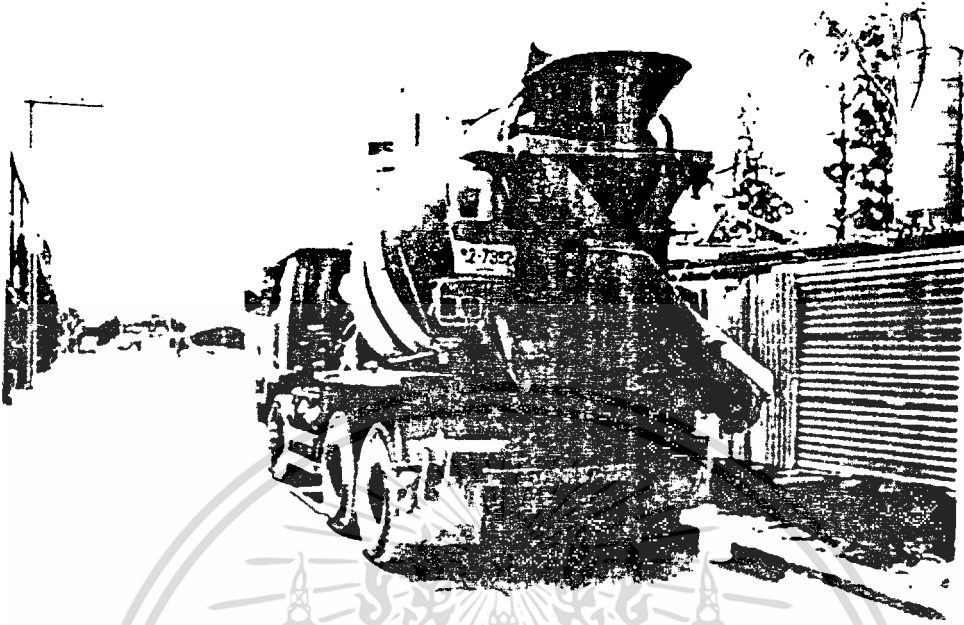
แสดงบริเวณโรงงาน Ready Mix Concrete
